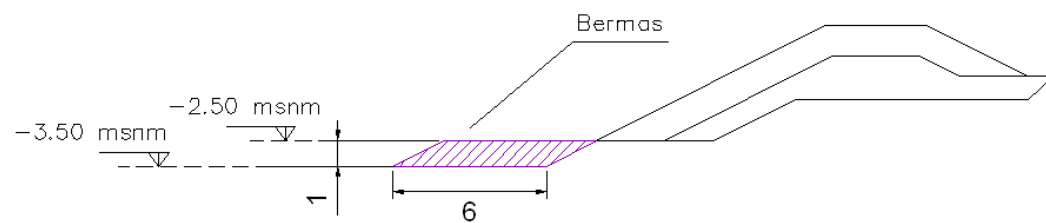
Esquema de las bermas proyectadas en la base del espigón. Cotas en metros.
